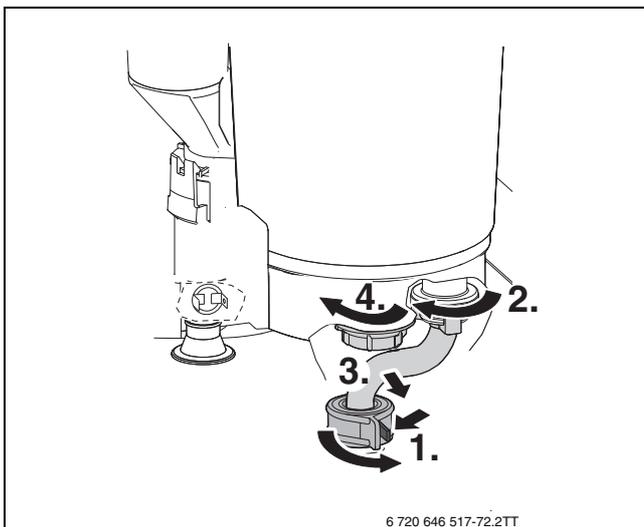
Mutter entfernen und Rücklaufrohr lösen
